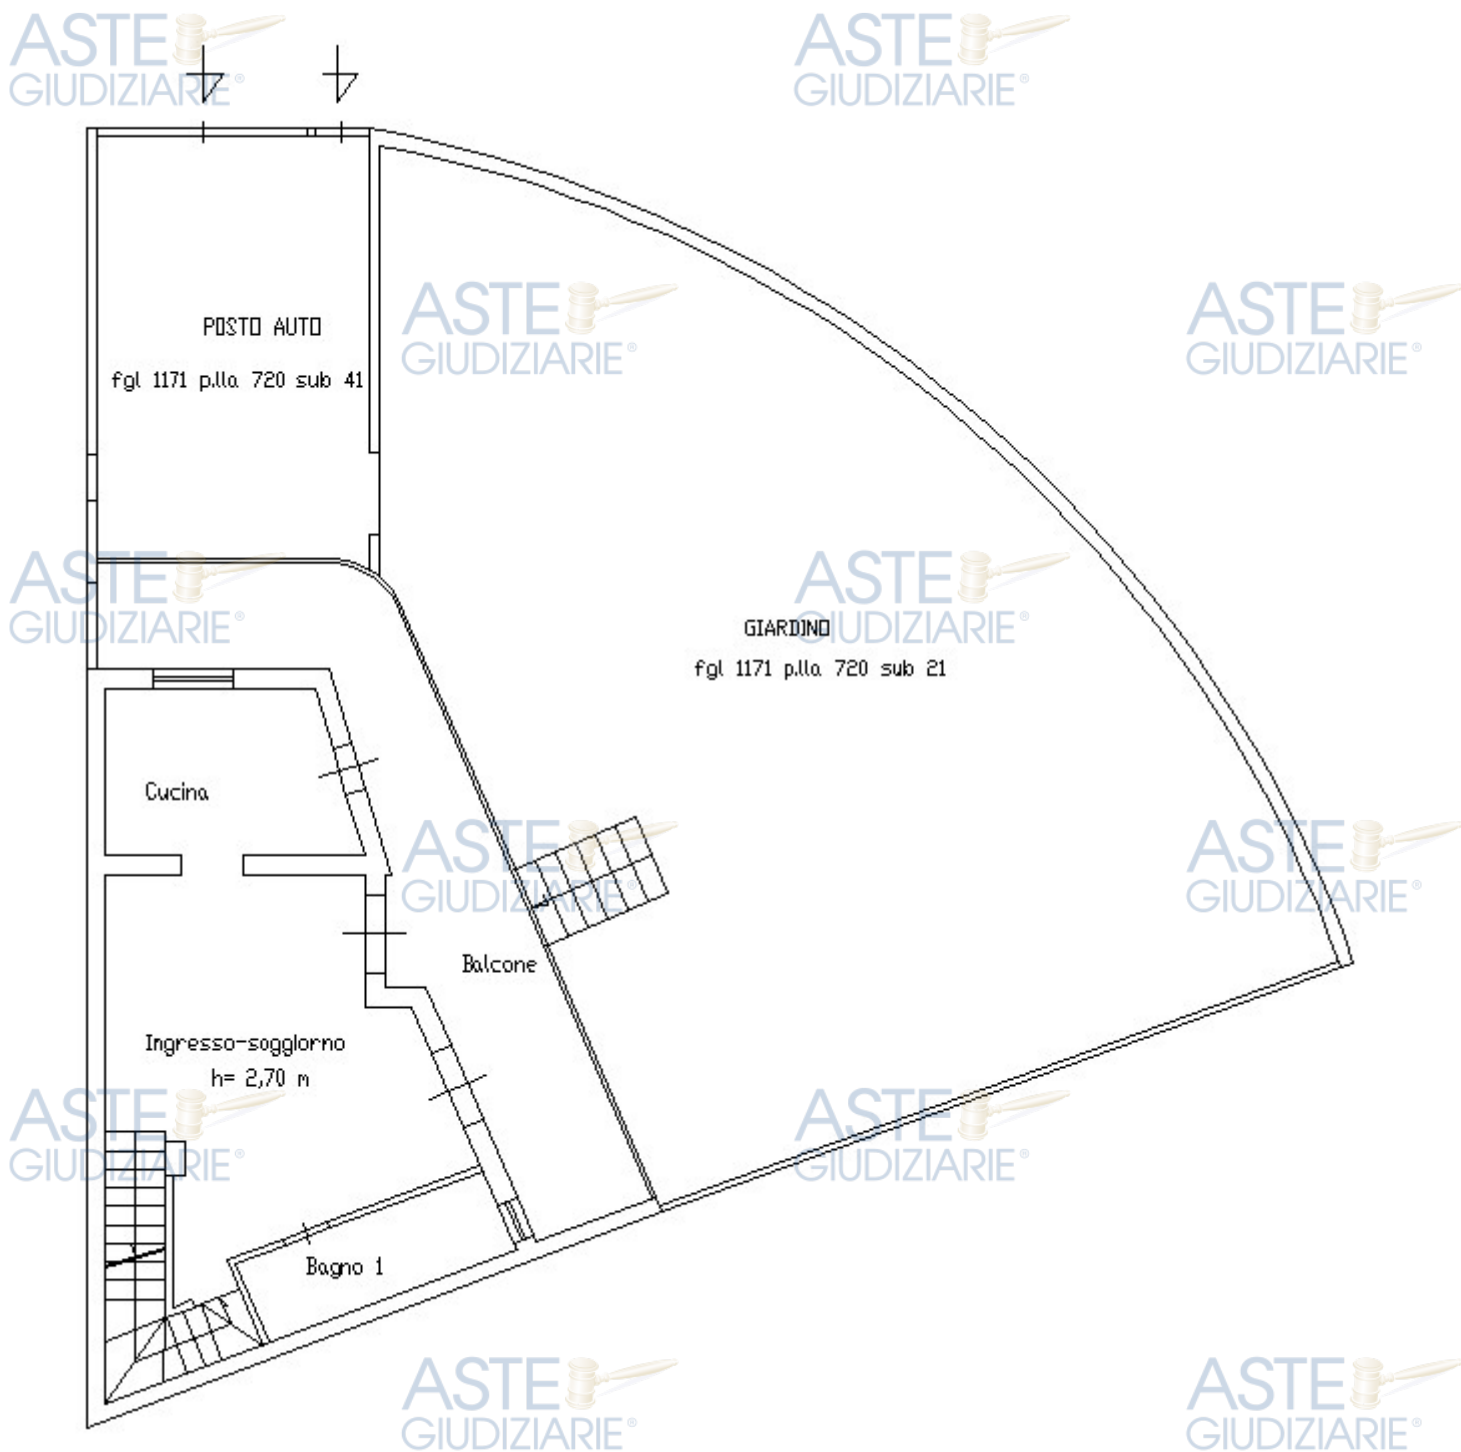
Planimetria della villa al piano terra - sub 5 graffata al sub 21/interno 5
